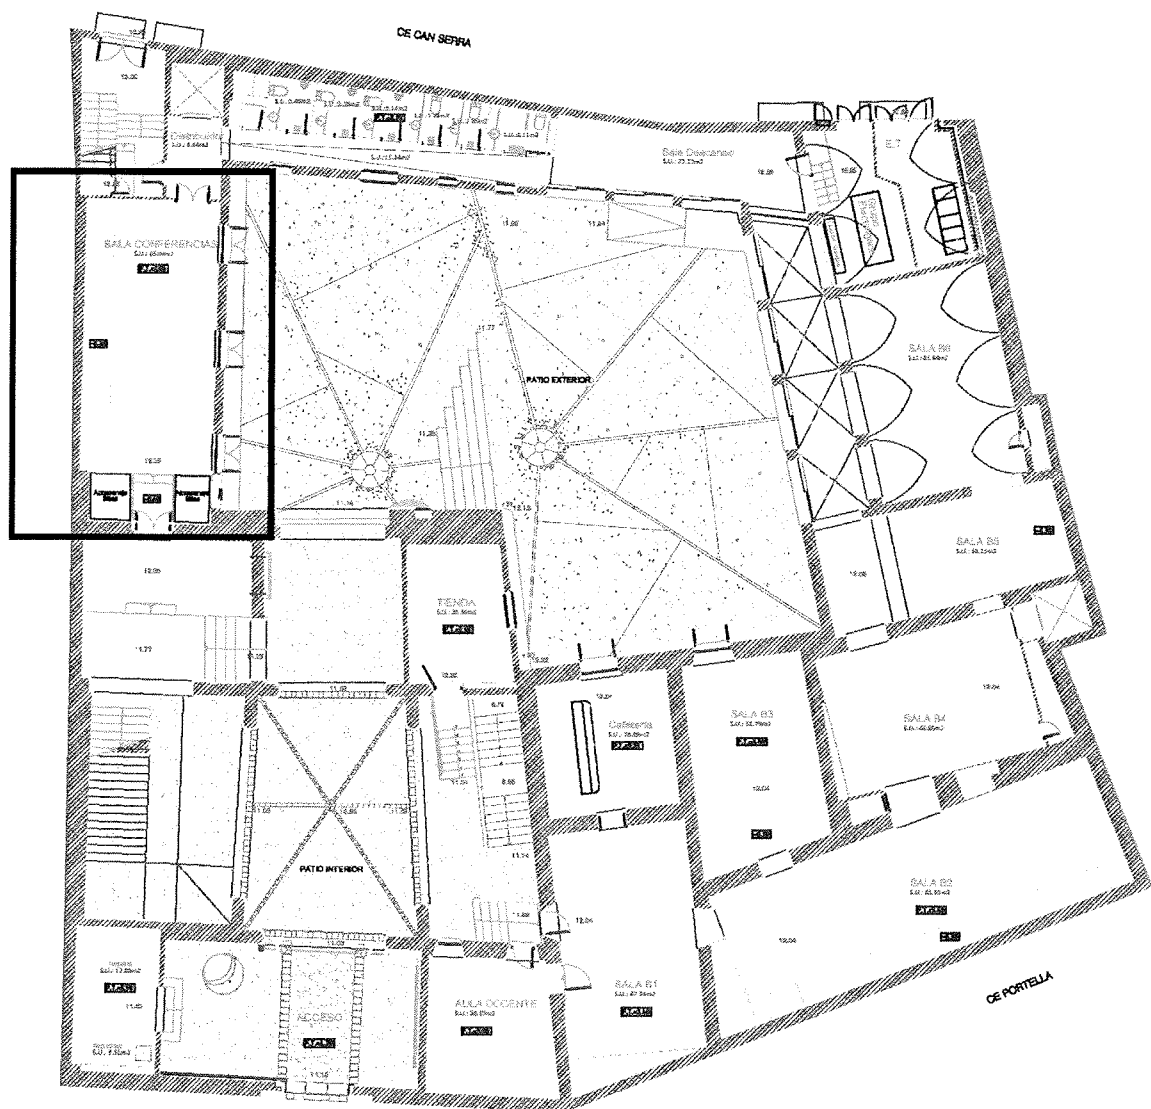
Planta primera del proyecto de restauración del Museu de Mallorca (Pedro Rabassa)
